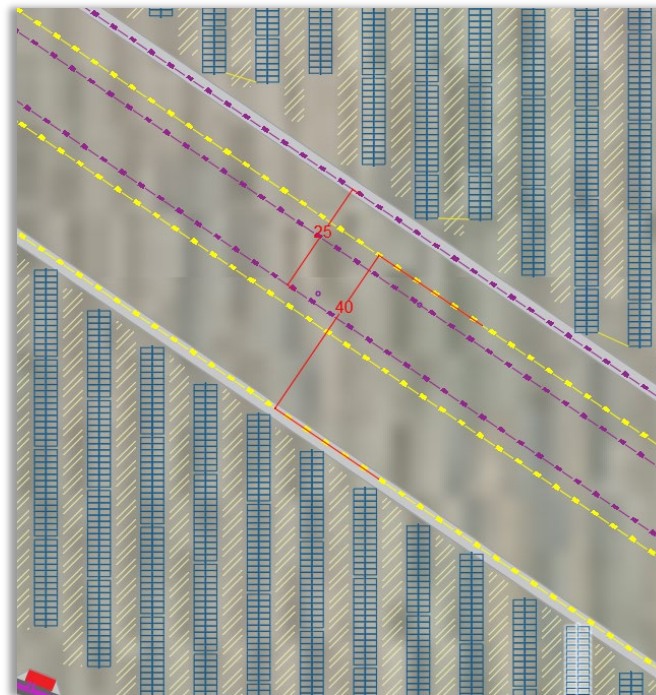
Layout Impianto con indicazione fasce di rispetto condotta SNAM
